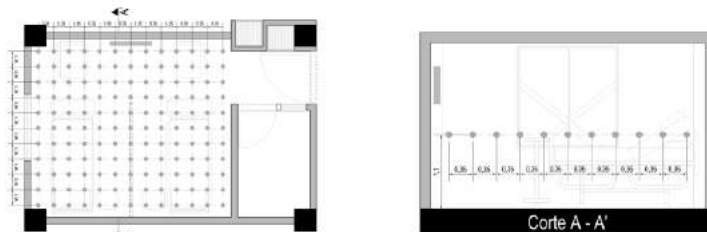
Grilla de análisis. Iluminancia. Planta y Corte A - A'
